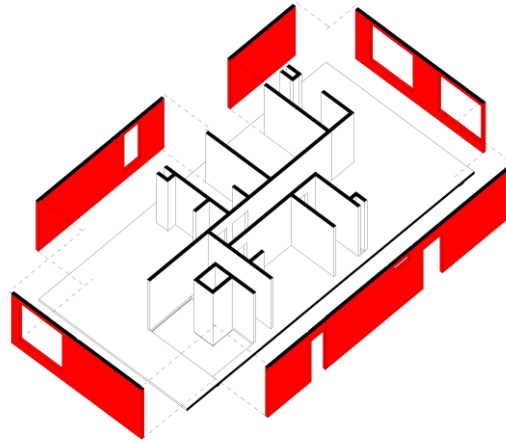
Sistema de Centro típico fachadas prefabricadas
